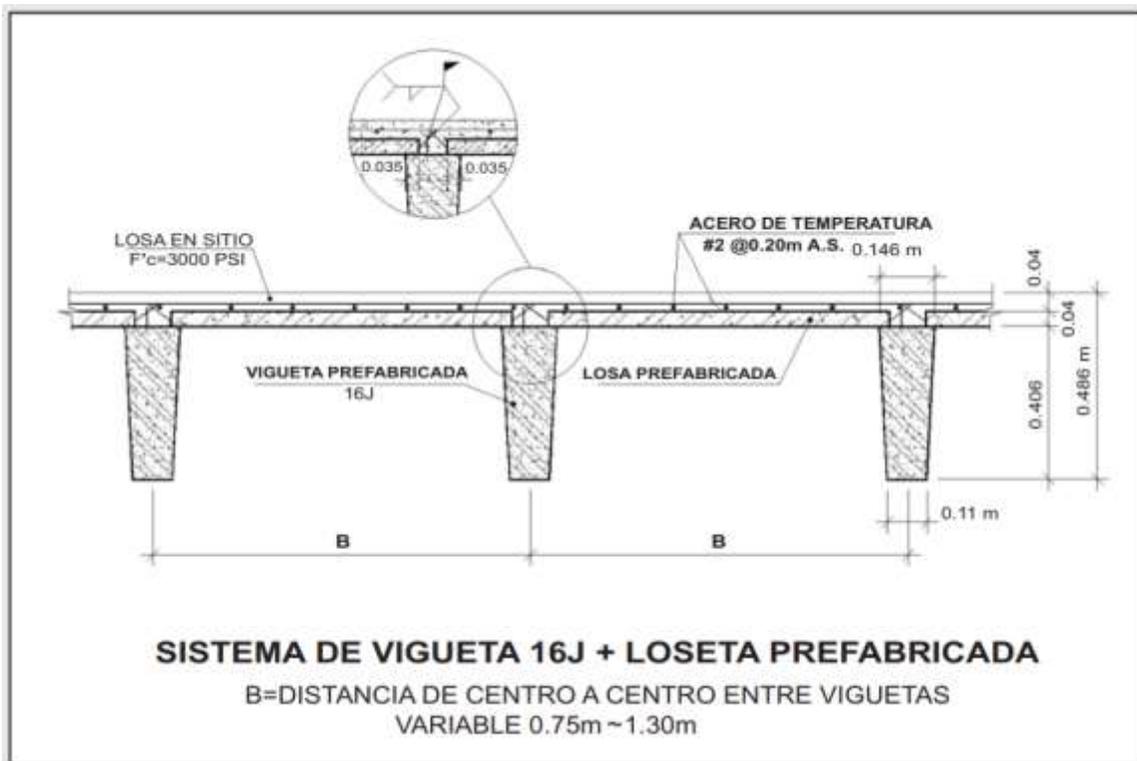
Sistema de entrepiso vigueta keystone + losa
